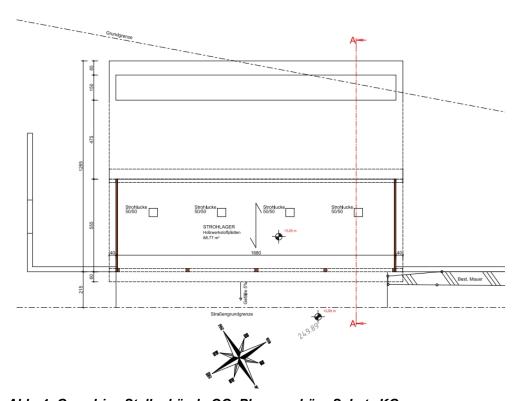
Grundriss Stallgebäude OG, Planungsbüro Schatz KG
